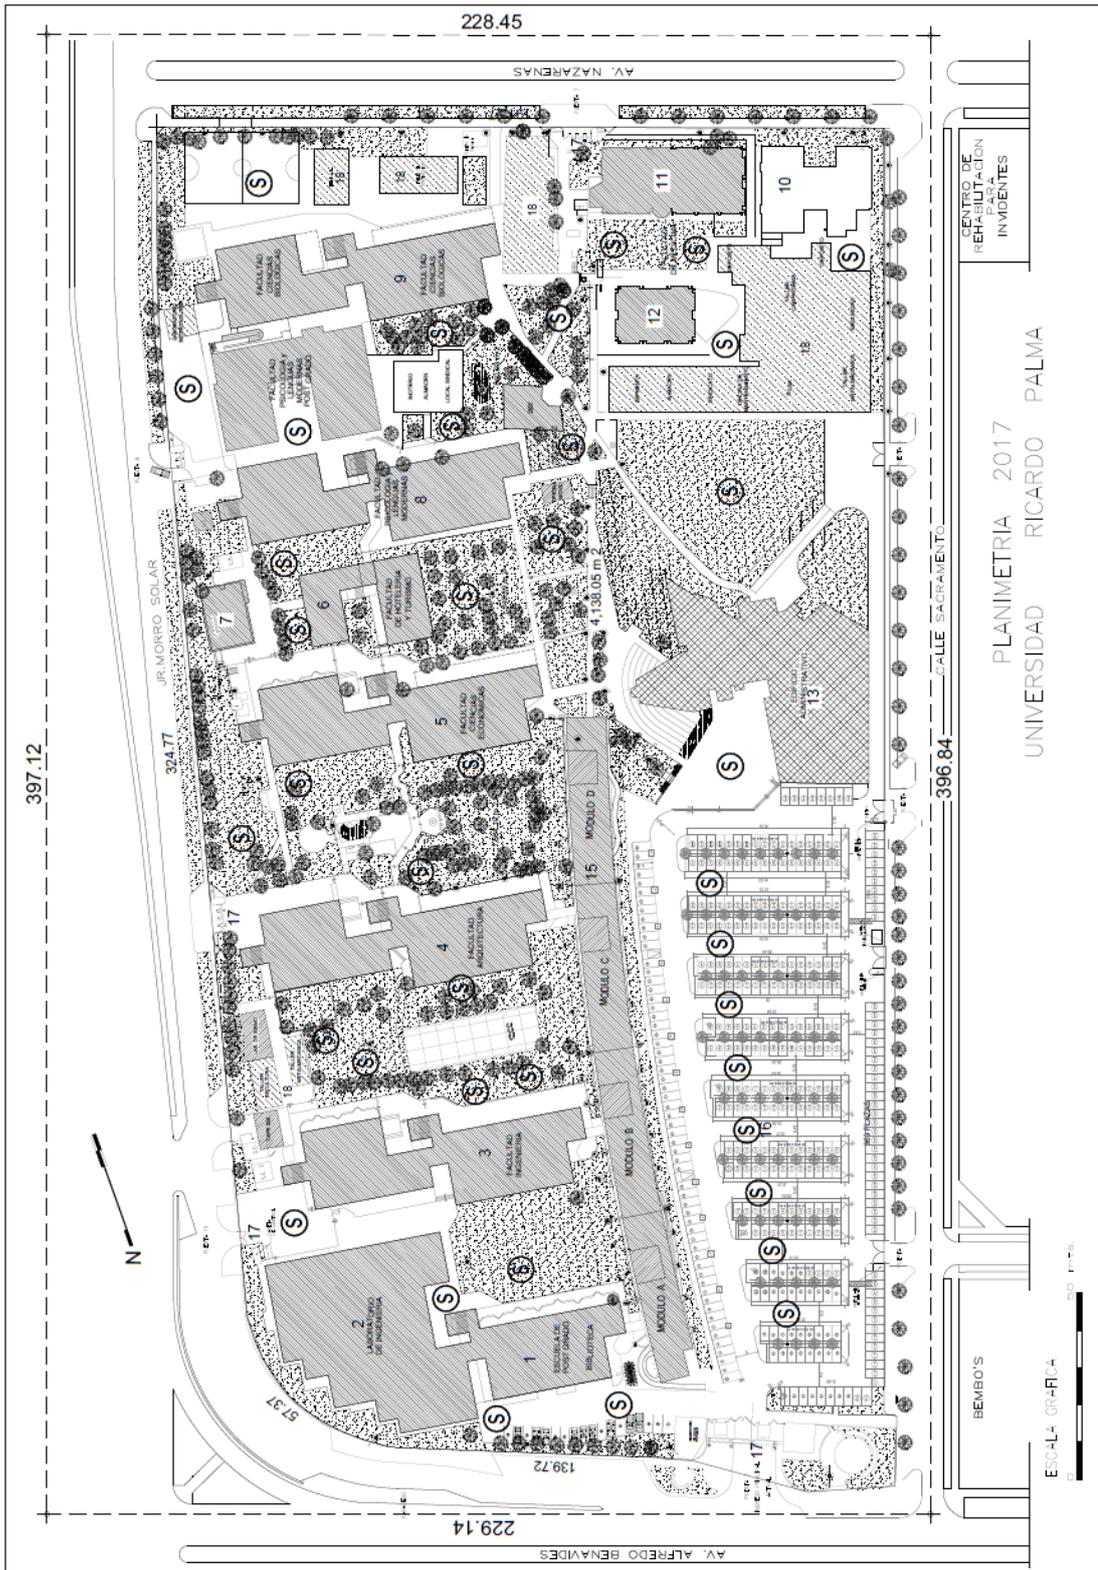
Planimetría de la Universidad Ricardo Palma
